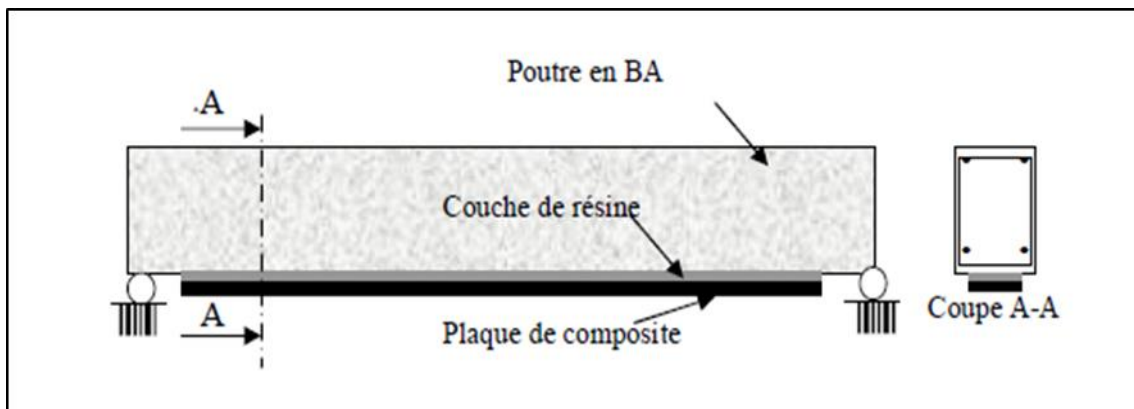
Plaque de composite collée sur une poutre en béton armé
